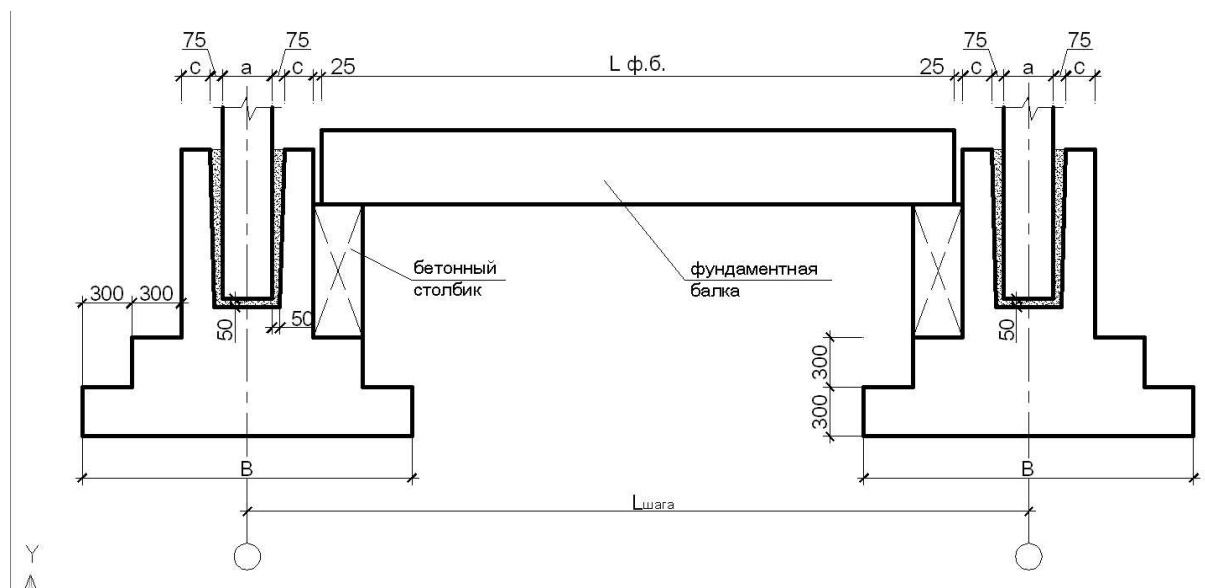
Устройство фундаментной балки под стены каркасных зданий
